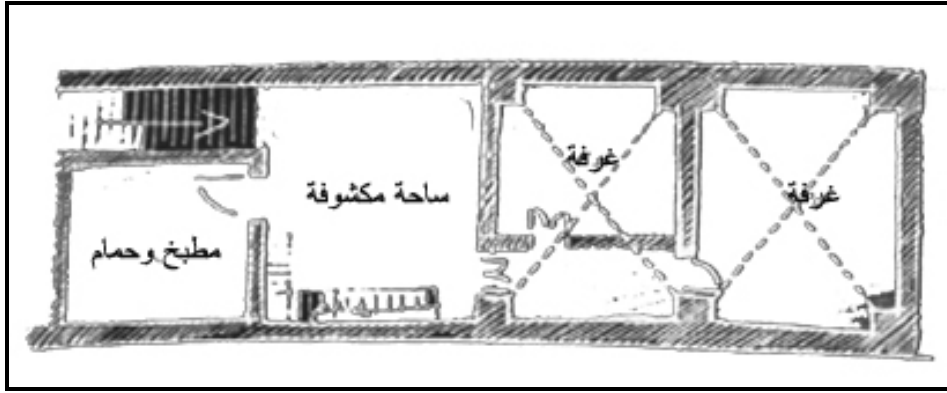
مخطط الطابق الأرضي لبيت ذو ساحة مكشوفة
